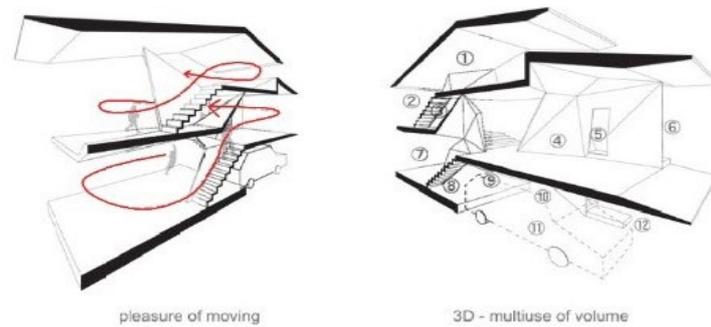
Aktifitas Denah Hunian New Kyoto Town House
